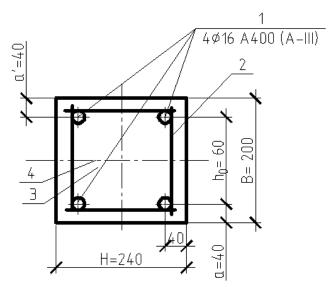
Армирование поперечного сечения верхнего пояса фермы
